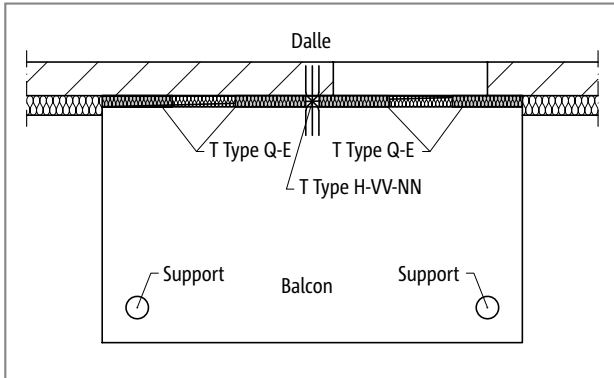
Schöck Isokorb® T Type H : Balcon avec appuis
